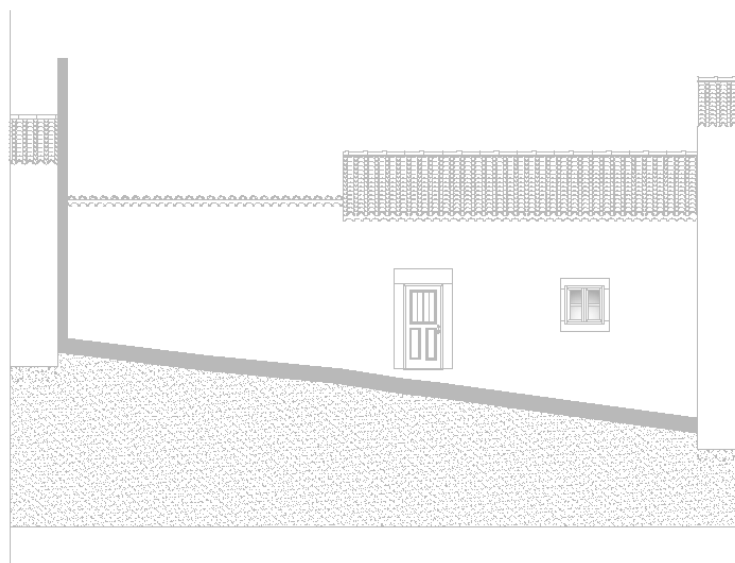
Levantamento da Fachada da Rua do Arressário nº 34
